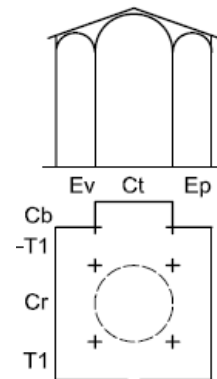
Esquema: planta y sección (S. Pedro Vaticano)
